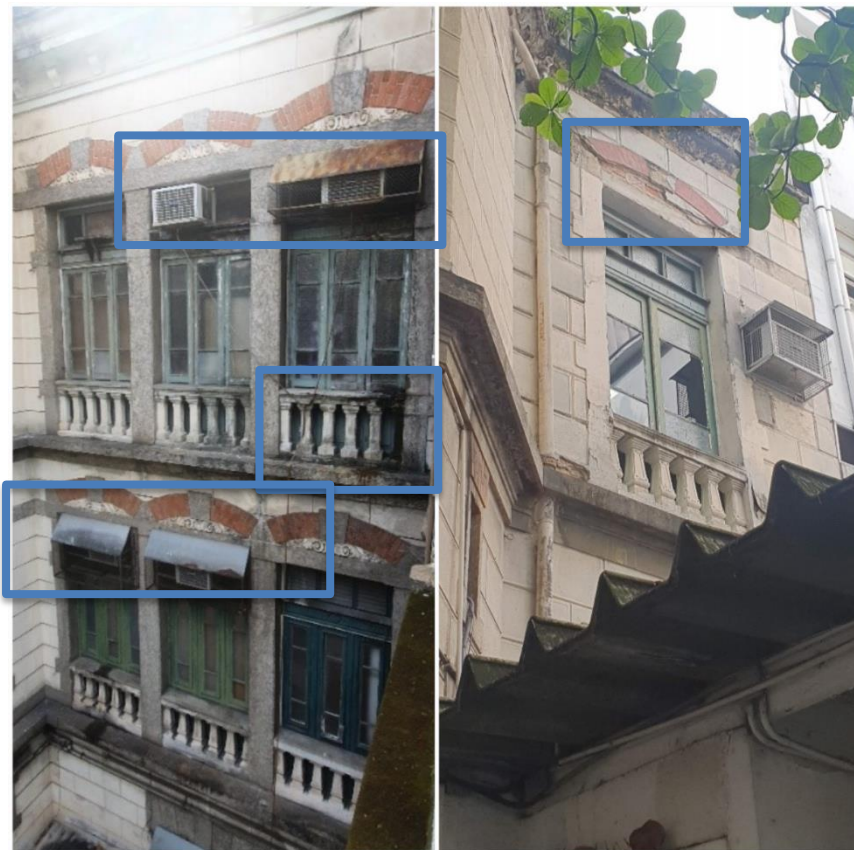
Fachada interna e lateral, com instalações aparentes, elementos que descaracterizam a fachada.
